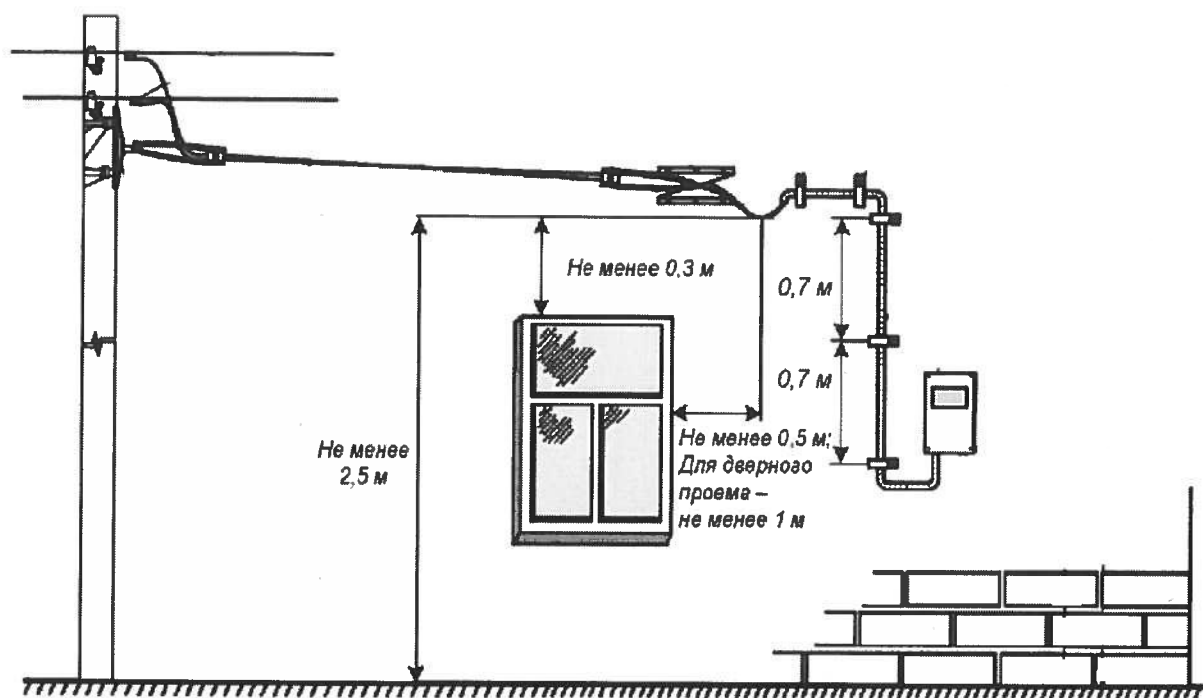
ШП на фасаде жилого дома (хоз. постройки) или фасаде забора
